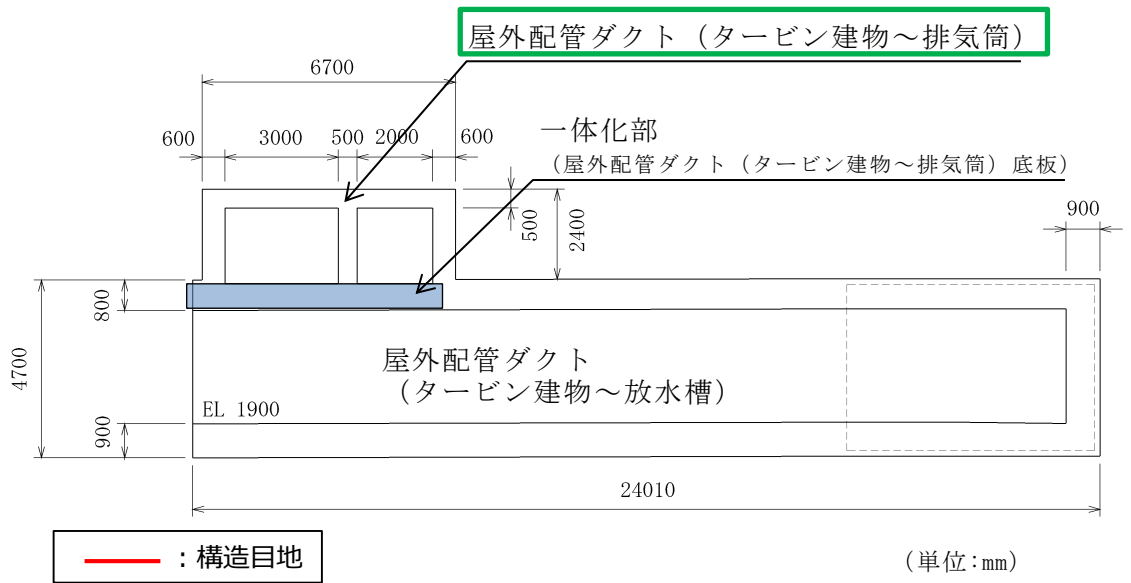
屋外配管ダクト (タービン建物～排気筒) 断面図 (B-B 断面)
